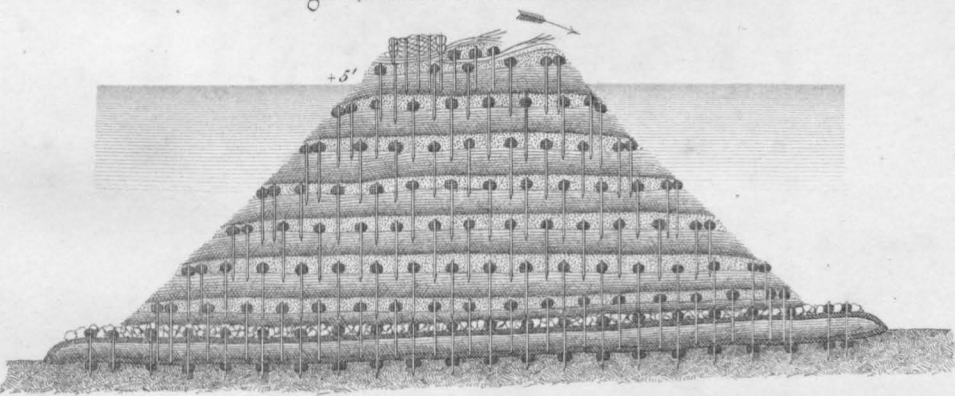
Aufsicht auf einen Bühnenkopf. 180
